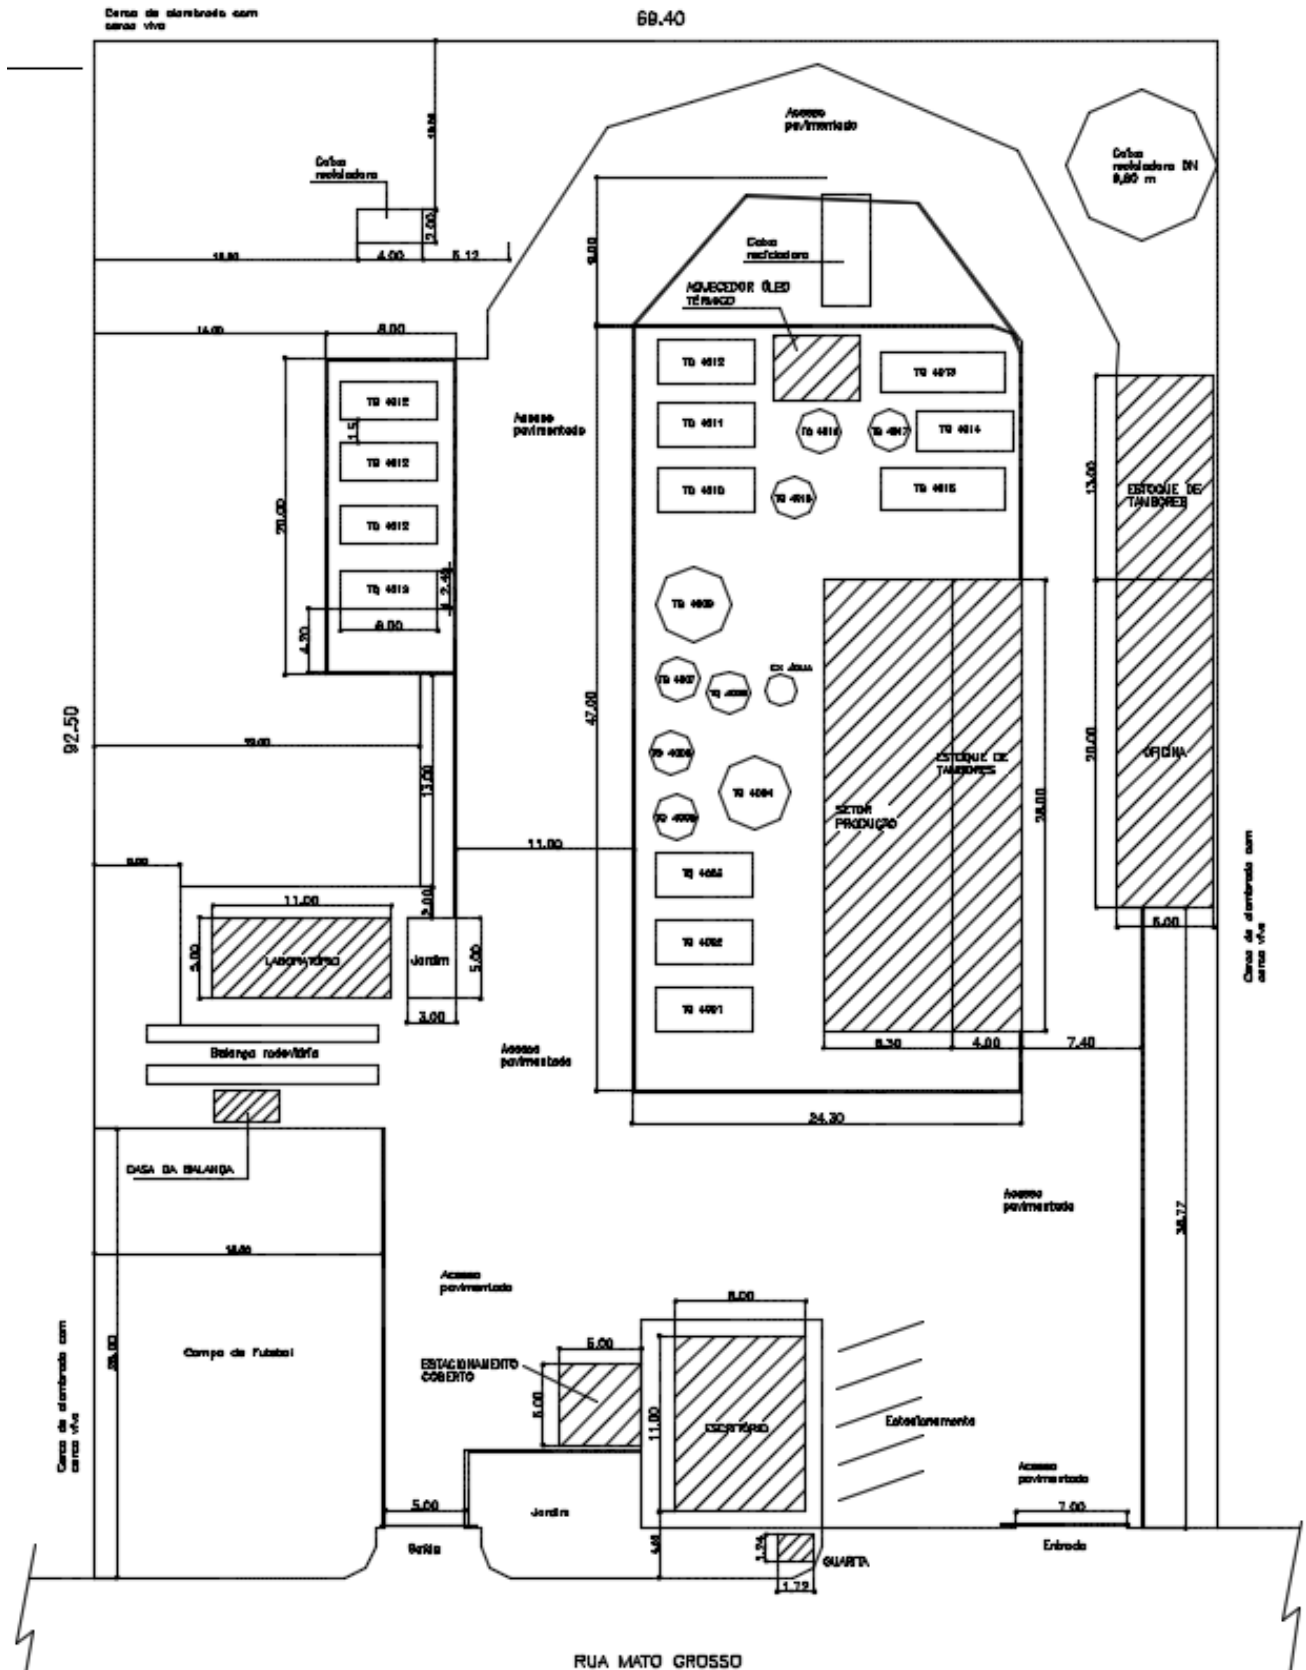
Planta baixa da STRATURA, Campo Largo – PR, com as edificações (escala 1:200/ unidades: m).
